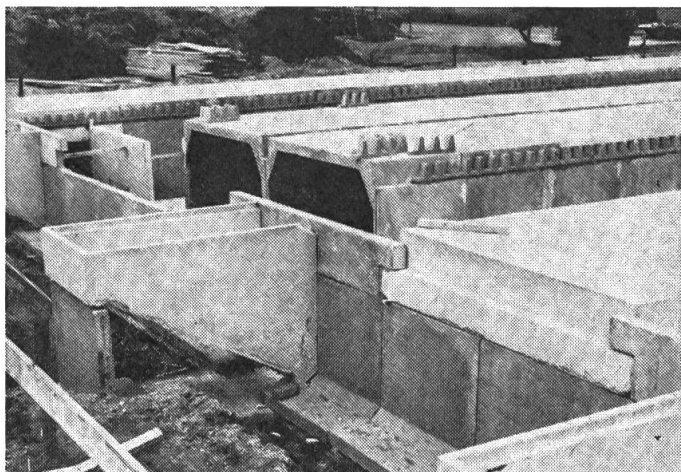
Mise en place du plancher à claire-voie (caillebotis).
